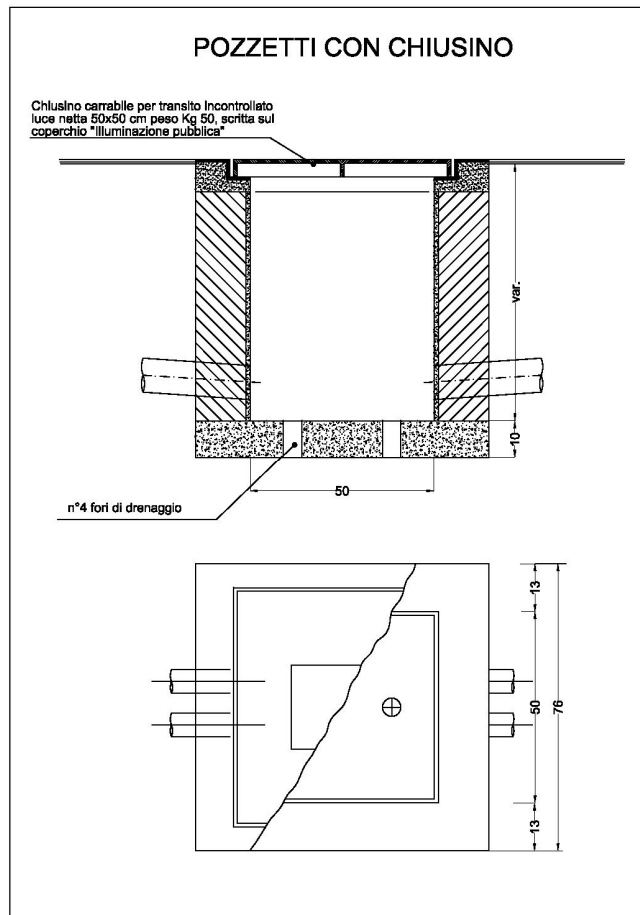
Rete illuminazione pubblica primaria – Pozzetto
